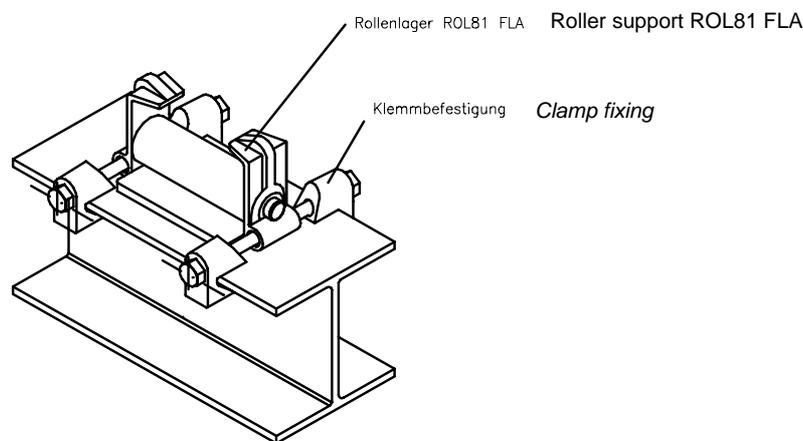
Rollenlager ROL81 FLA mit Klemmbefestigung
